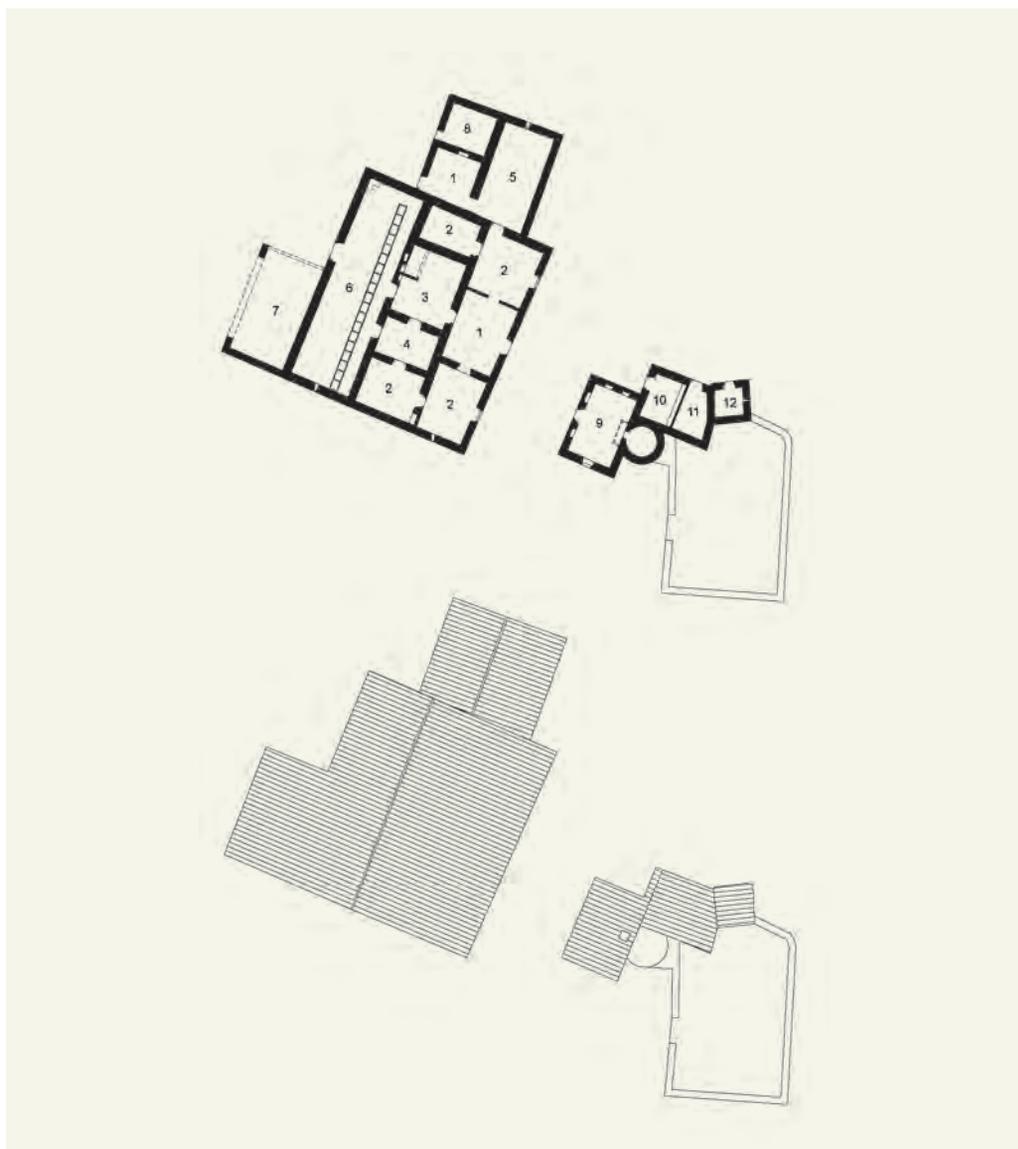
· Reconstituição do Monte de Baixo (escala 1/600)
